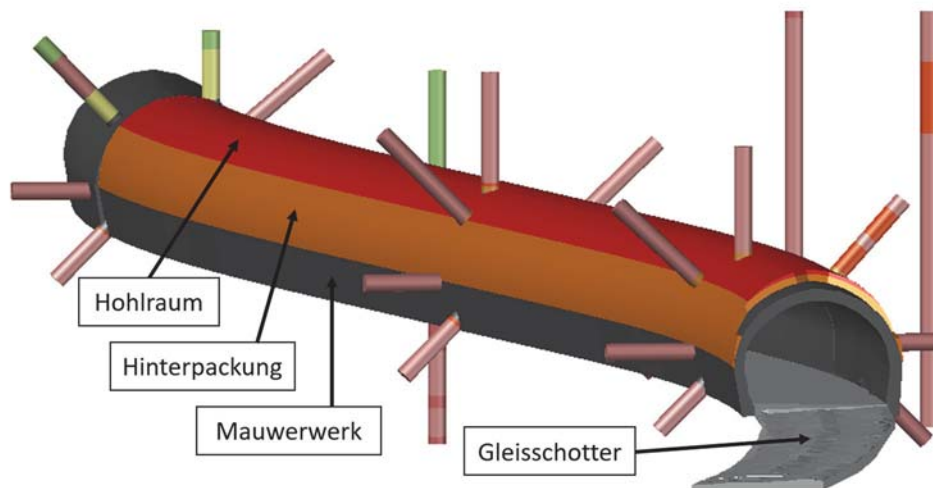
Elemente des Bestandstunnels gemäß Bohraufschlüssen
